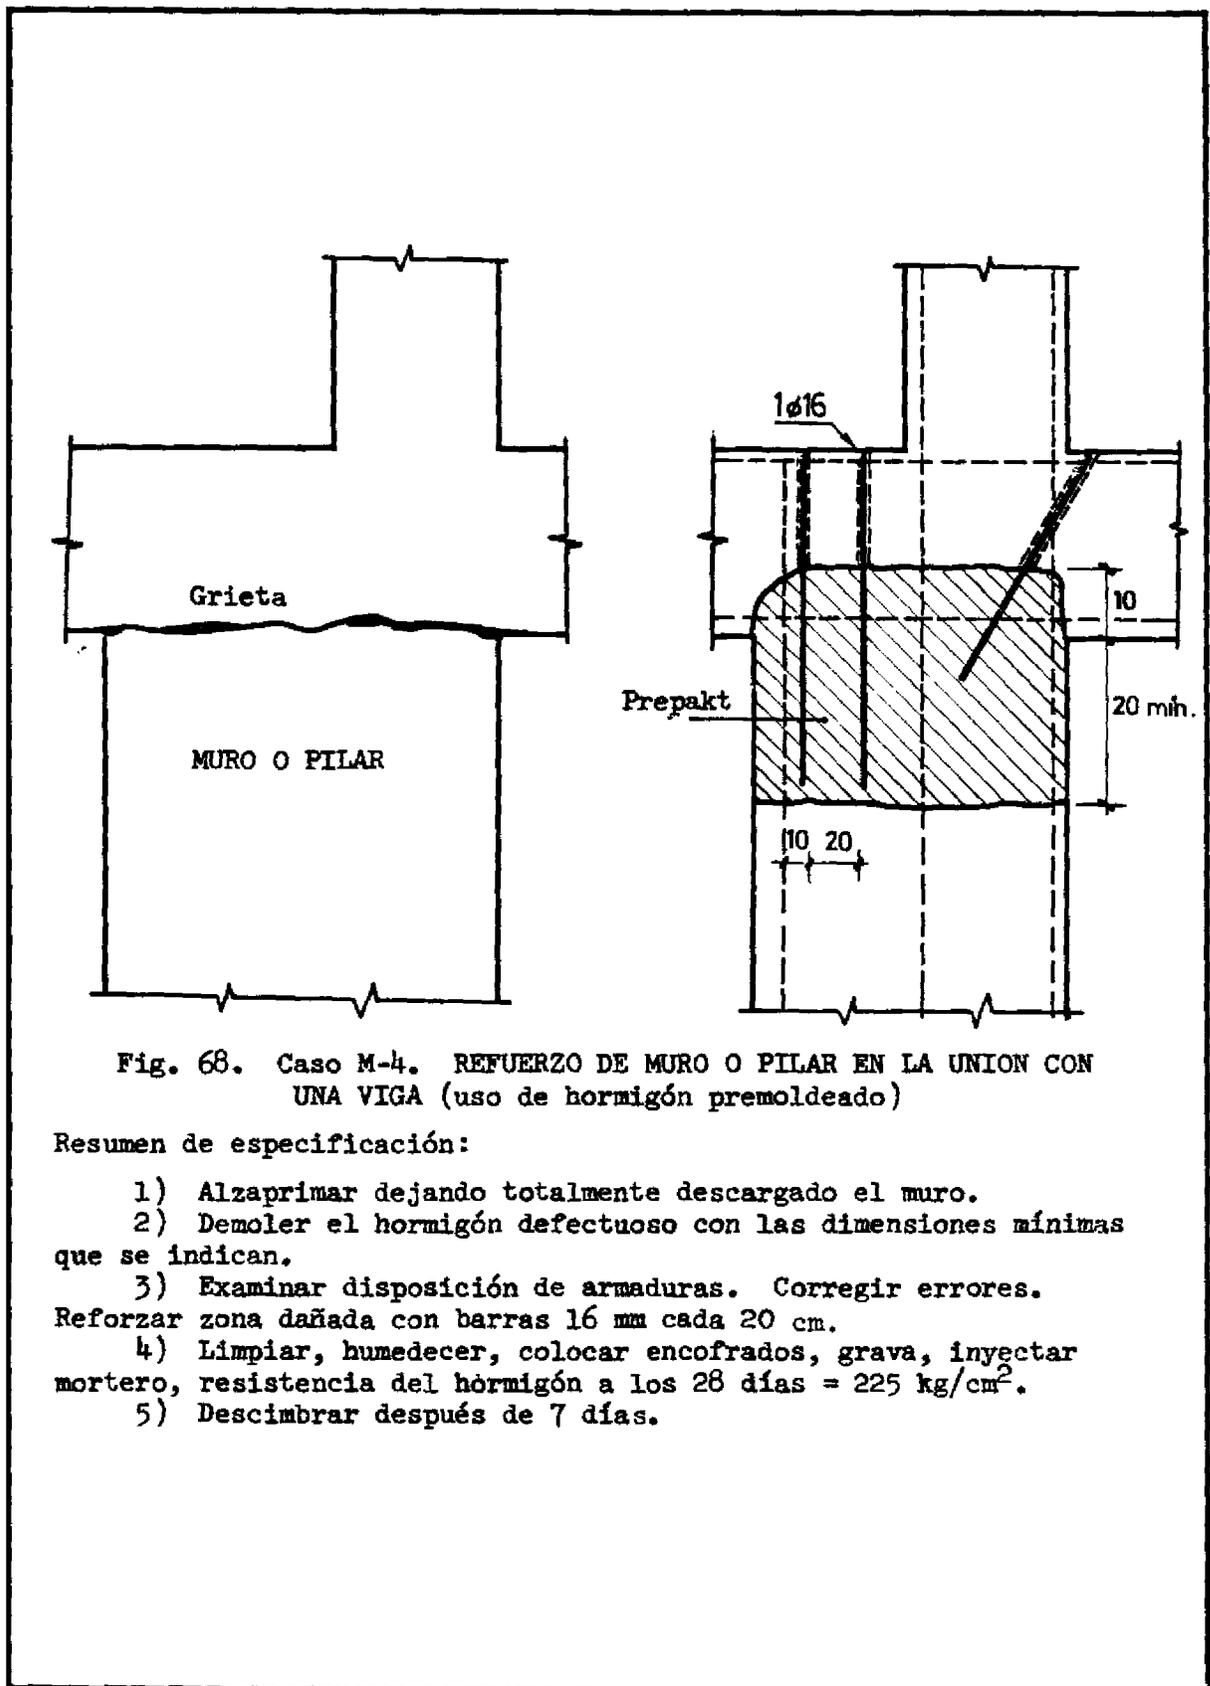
Caso M-4. REFUERZO DE MURO O PILAR EN LA UNION CON UNA VIGA (uso de hormigón premoldeado)
